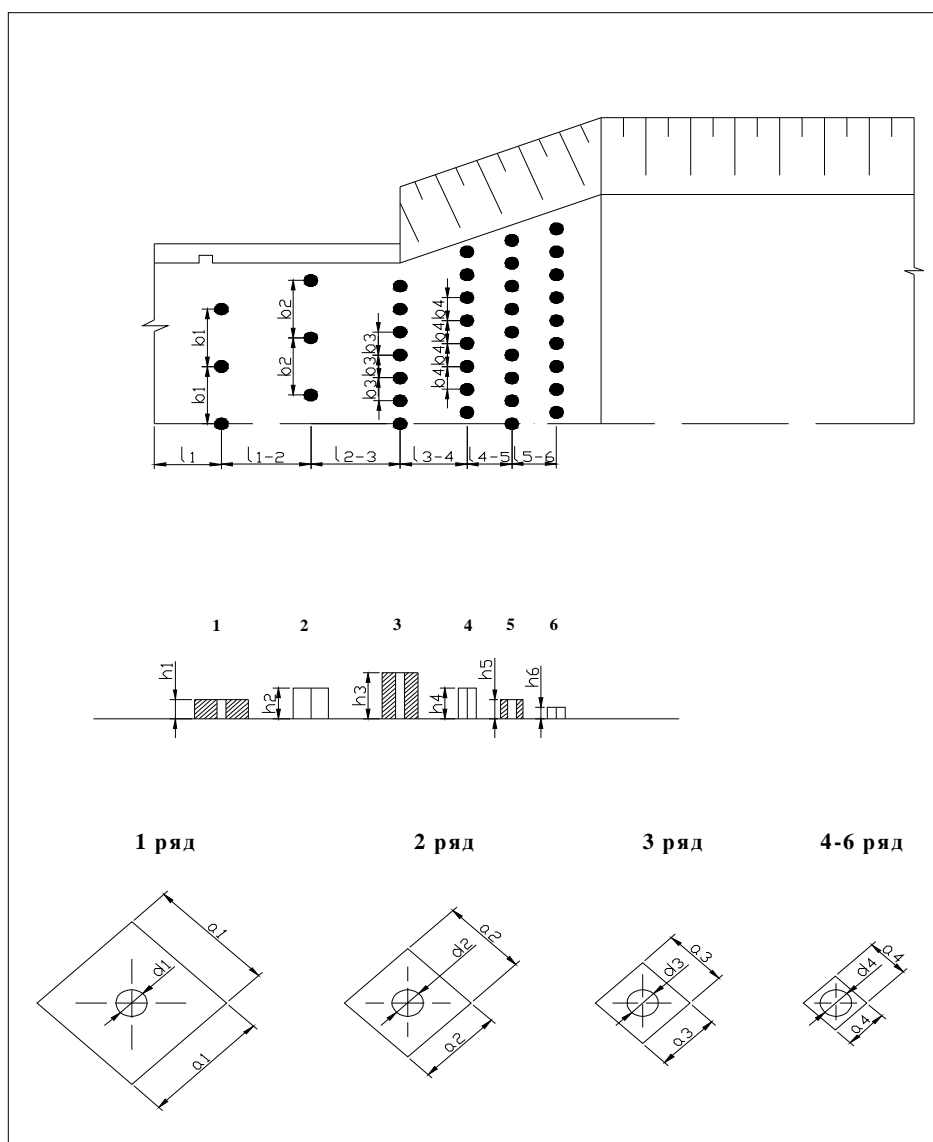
Конструкция свайно-шашечного гасителя с подачей воздуха
